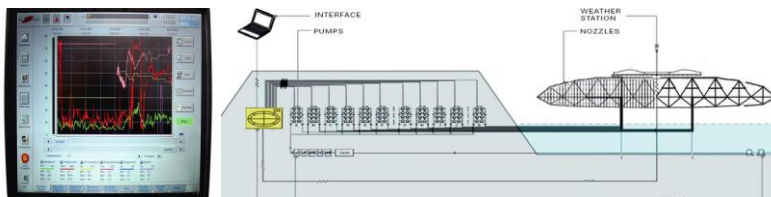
Sistema Plataforma, Blur building, Fuente: (Blur Building, s. f.)
